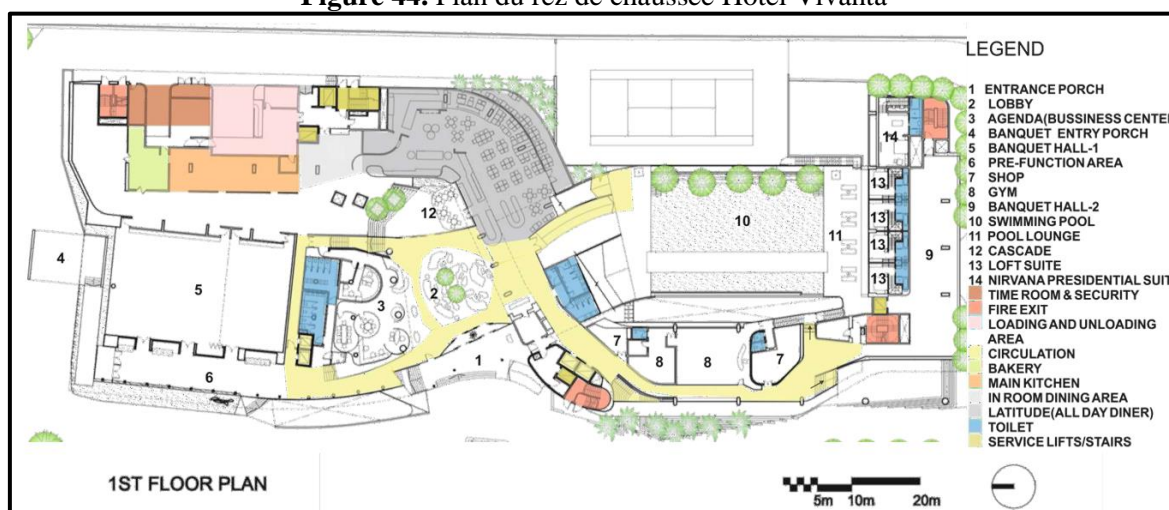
Plan du 1<sup>er</sup> étage Hôtel Vivanta
